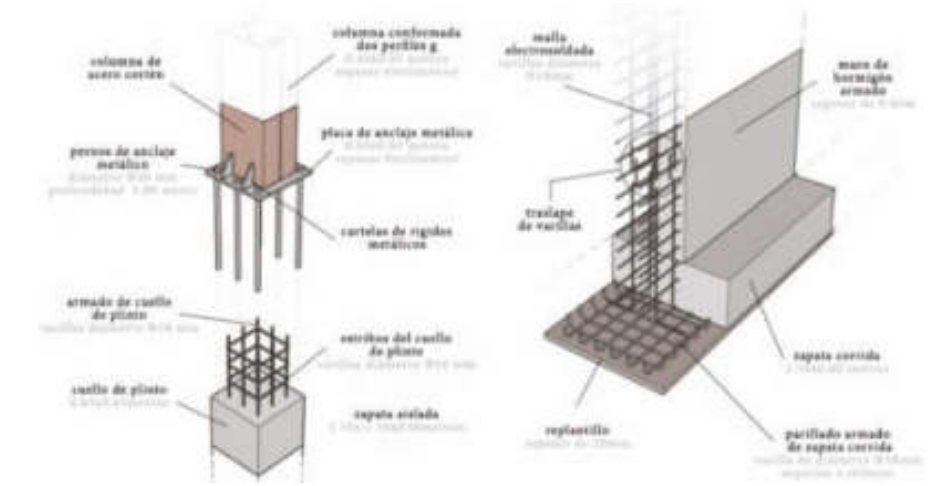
Detalle de cimentación-columna y Cimentación-muro
